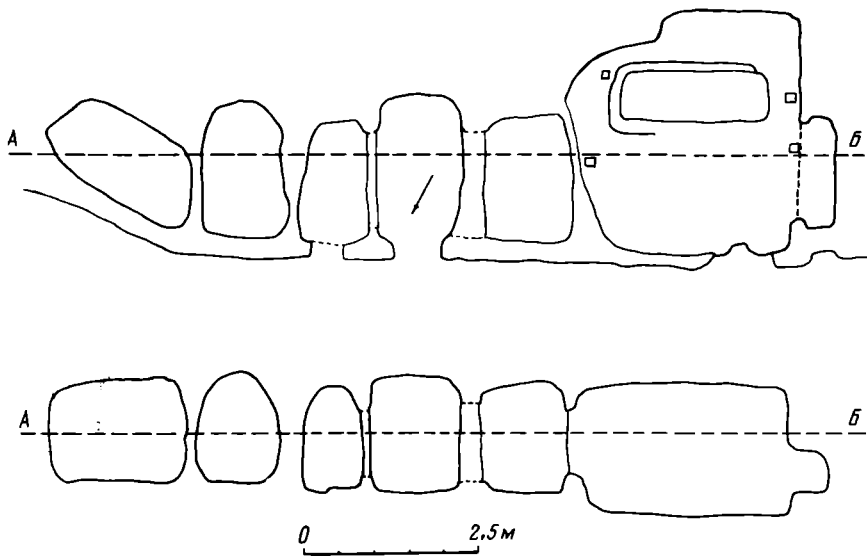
План и разрез пещерного комплекса над главными крепостными воротами в балке Капудере
